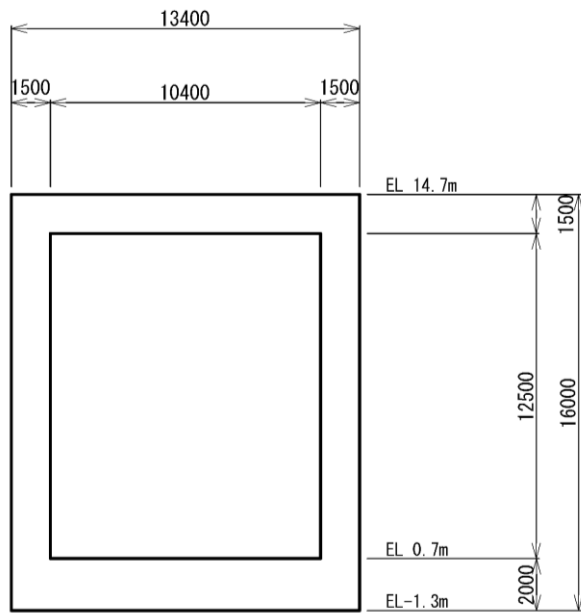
低圧原子炉代替注水ポンプ格納槽 平面図
